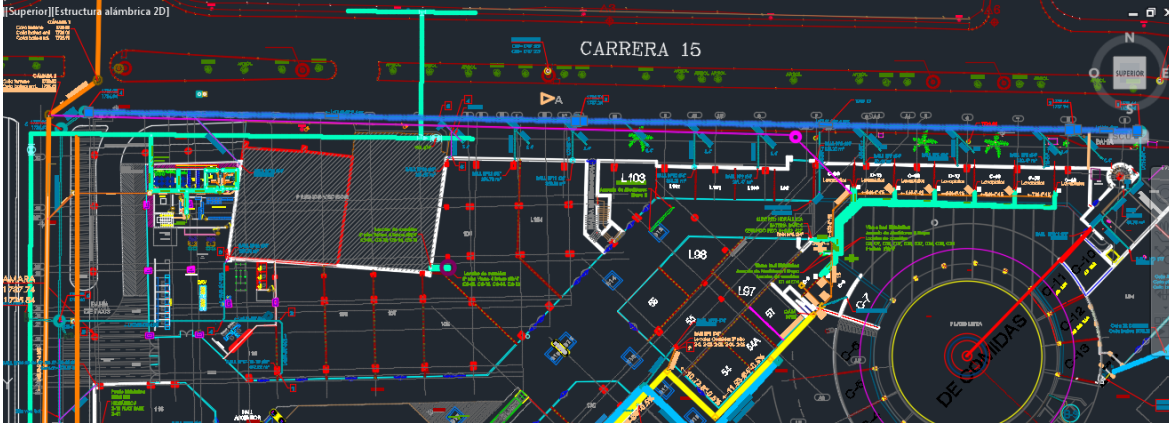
vista en planta, alcantarillado pluvial. (Fuente: Diseño ARINSA)
